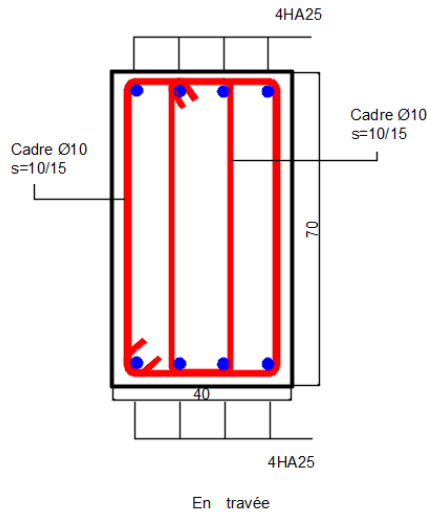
Ferrailage des poutres 70× 40 (En travée).
